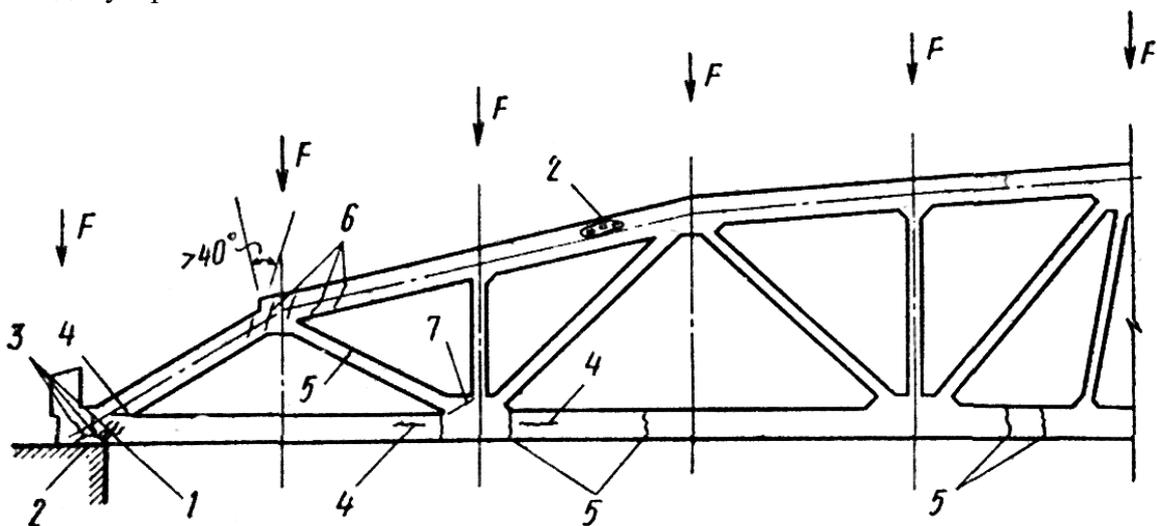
Характерные повреждения силового происхождения в железобетонных фермах
